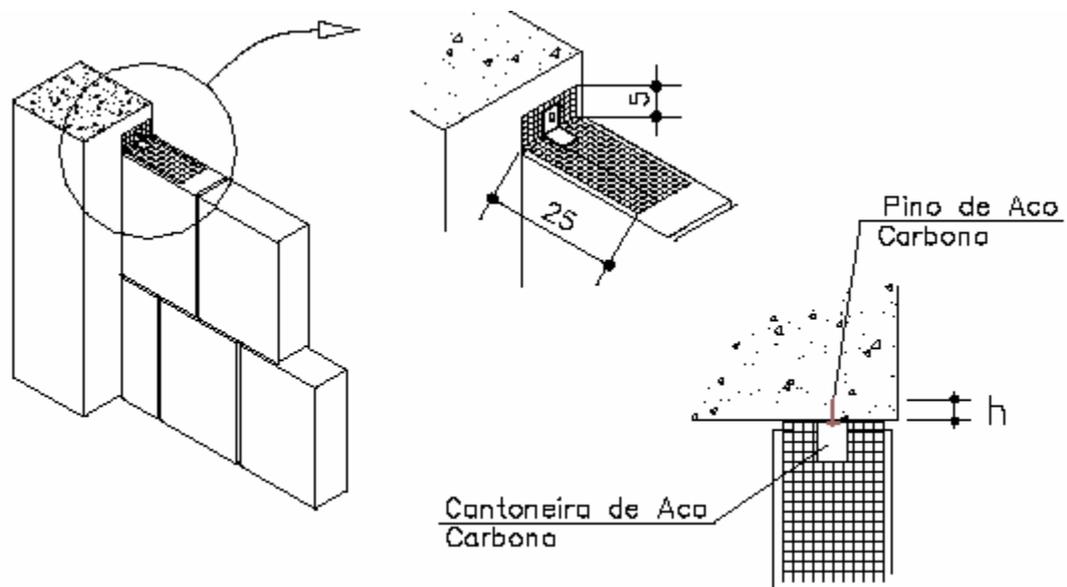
Detalhe de uma ligação entre alvenaria e pilar com a utilização de telas metálicas
